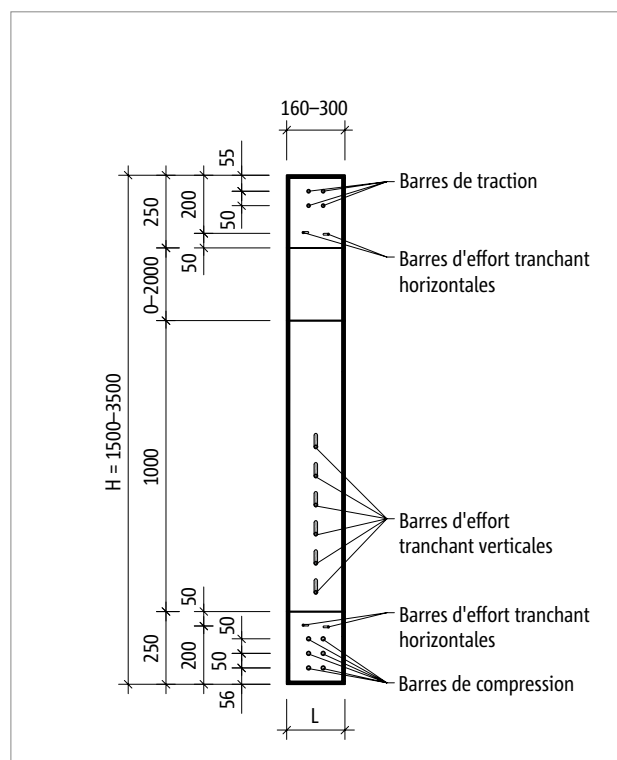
Schöck Isokorb® T type W-M4-R90 : vue du produit ; plaques coupe-feu sur tout le pourtour
